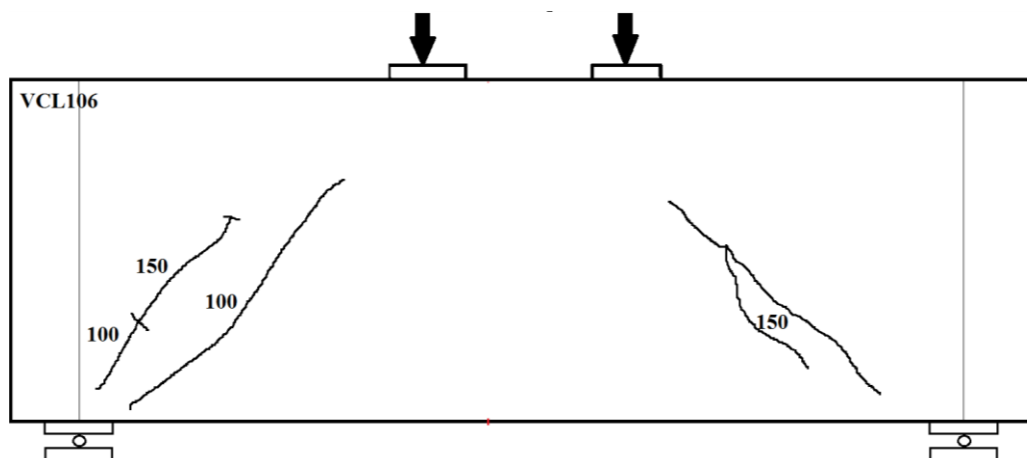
Esquema de fissuração da viga VCL106.
